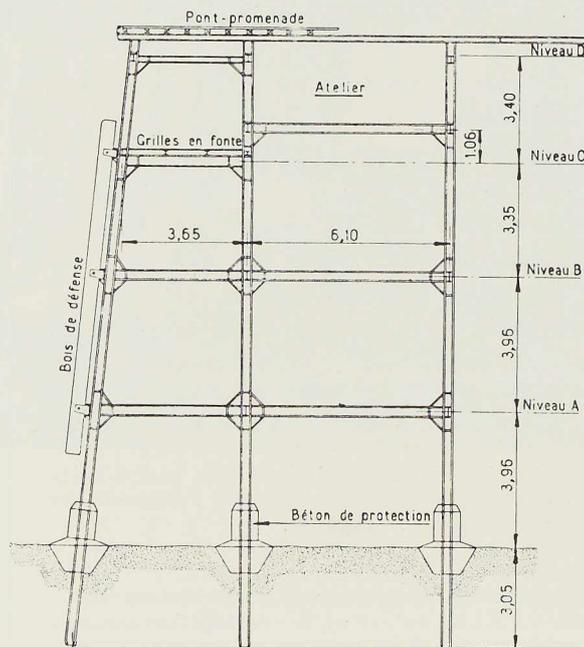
Coupe transversale dans la partie nouvelle du pier.
